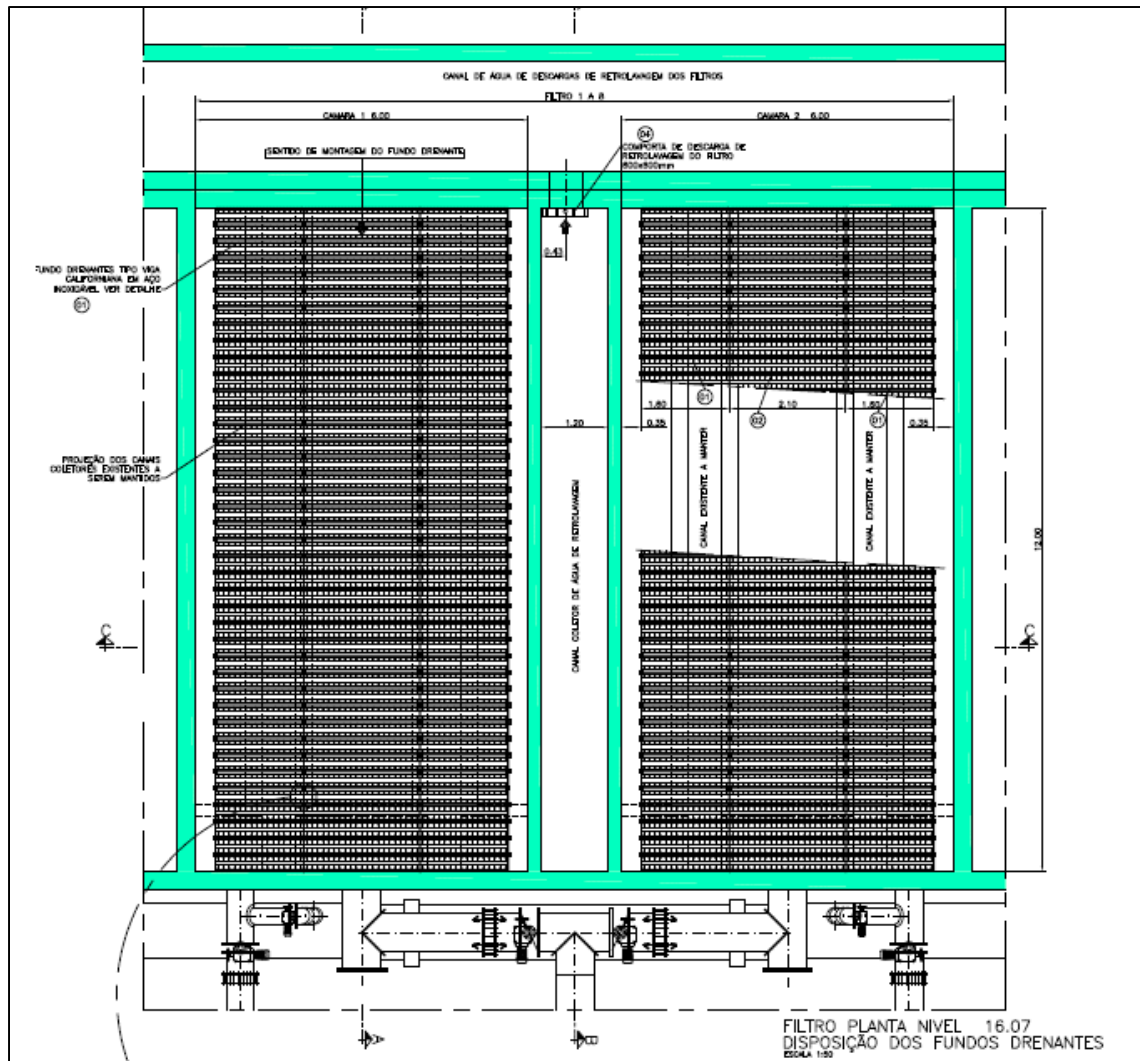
Planta de uma unidade de filtração típica da primeira etapa da ETA Bolonha após as suas obras de reforma – Disposição das vigas californianas e fundo falso
